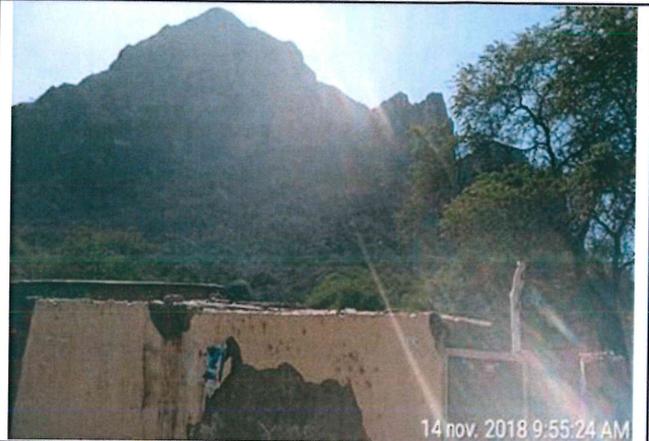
Vivienda de quincha en mal estado y sin techo.
